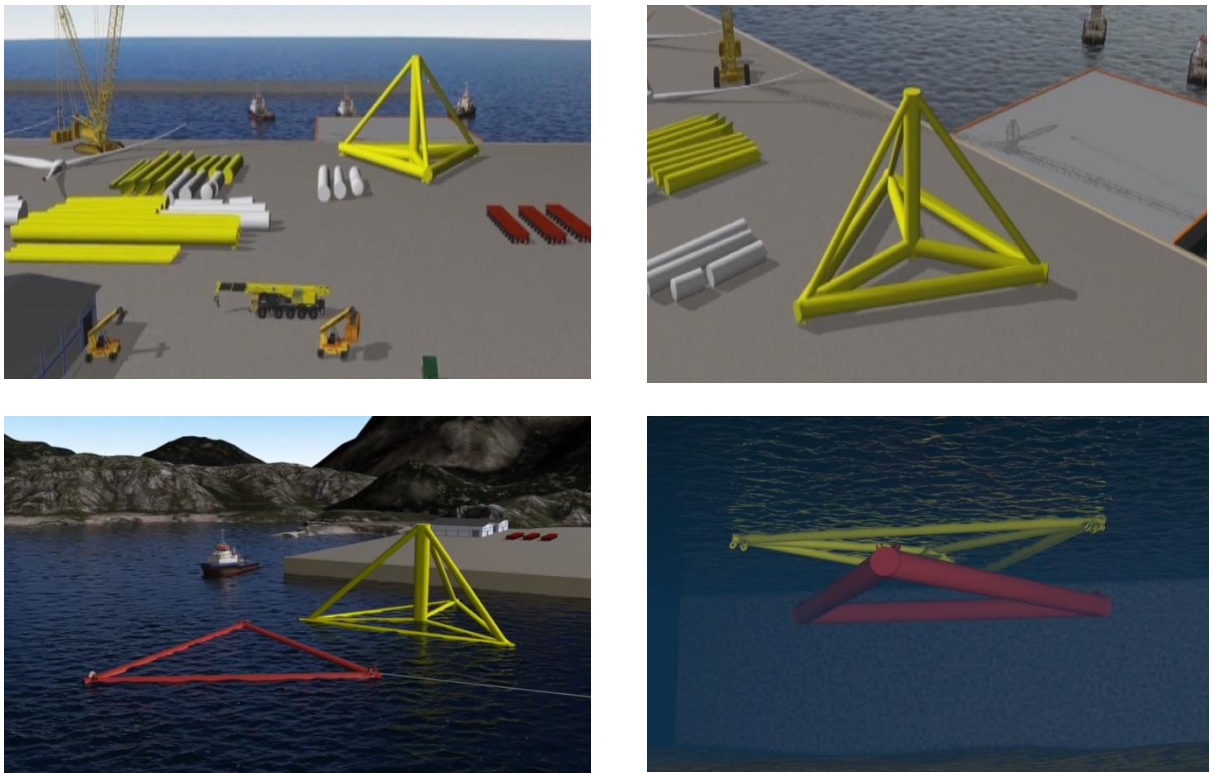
Fasi di assemblaggio della piattaforma galleggiante (Fonte: SOT A/S)
